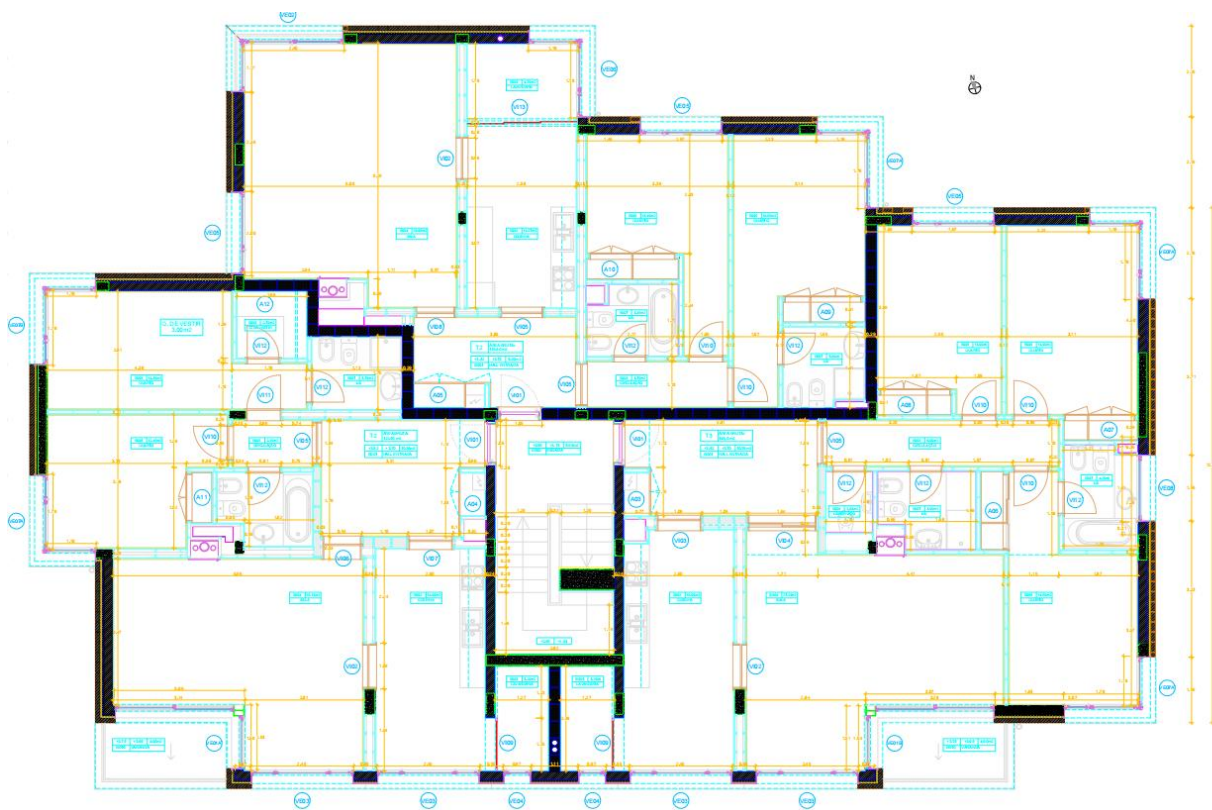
Planta Piso 1 e 2 (FONTE: Ficheiro AutoCad – projeto de arquitetura)
